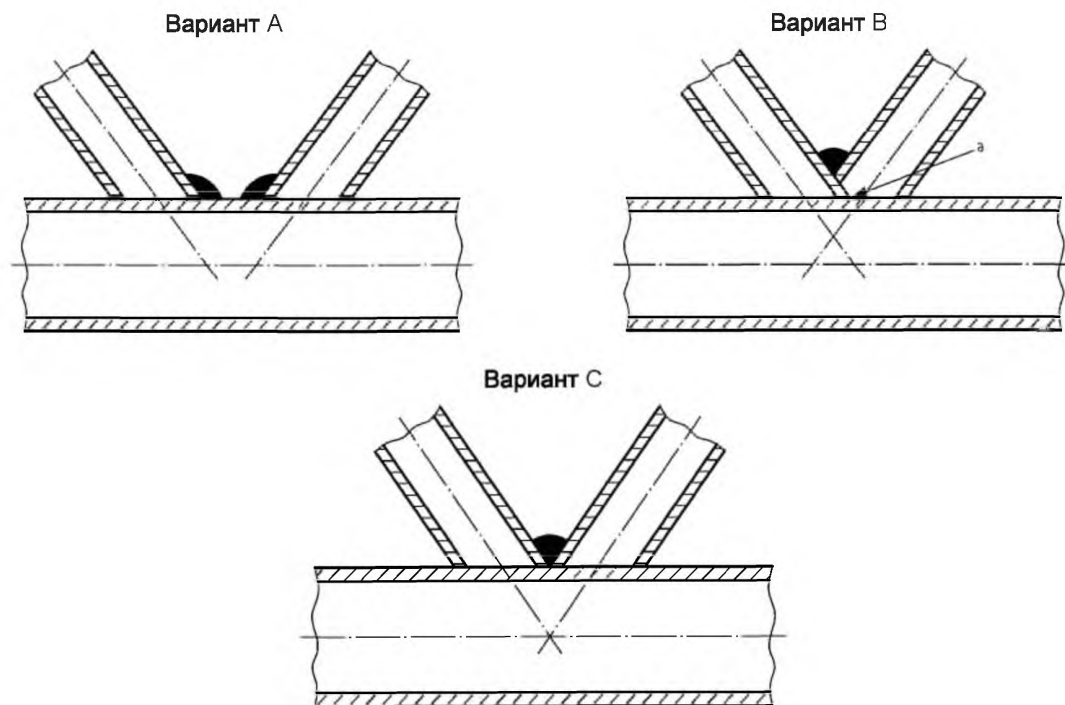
Подготовка замкнутых элементов под сварку и пригонка, при расположении их под углом
